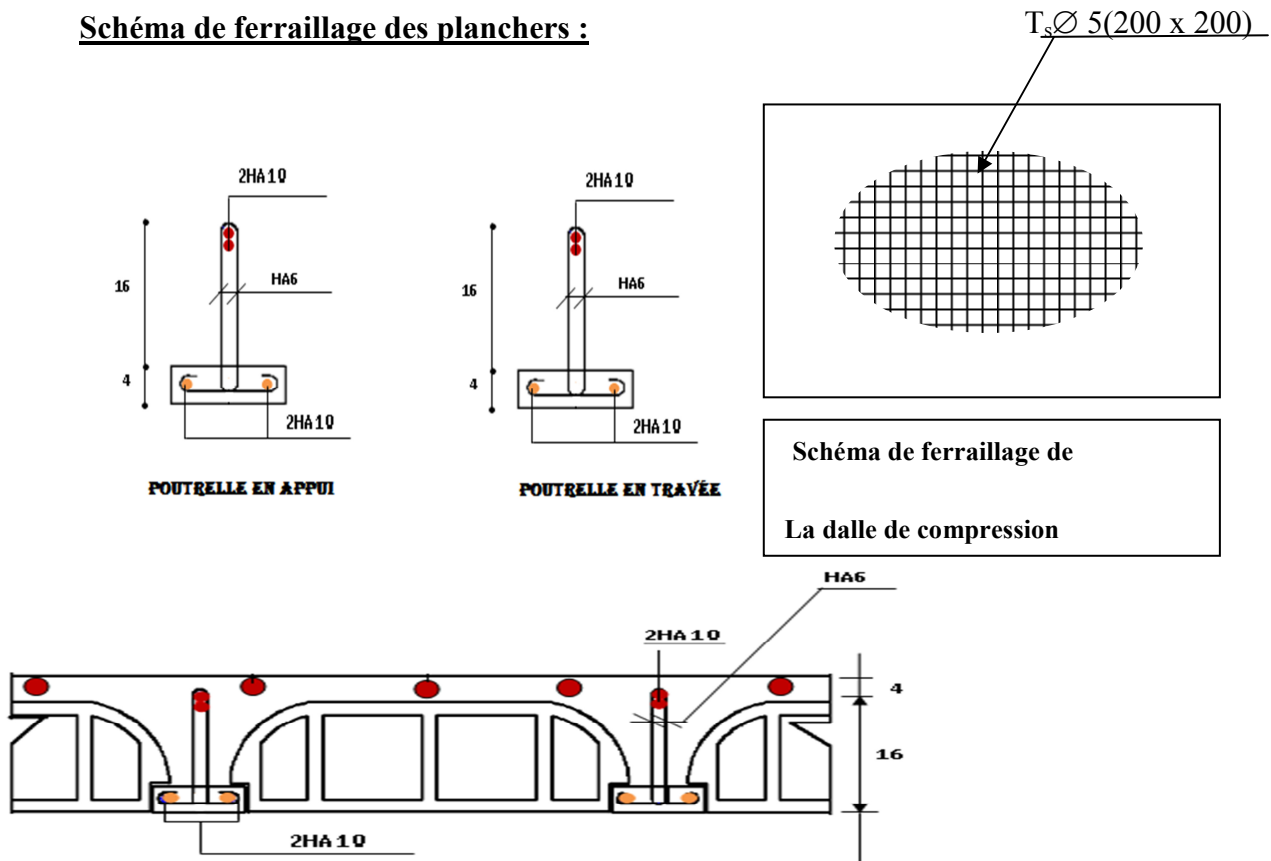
Ferraillage de la poutrelle et de la dalle de compression
